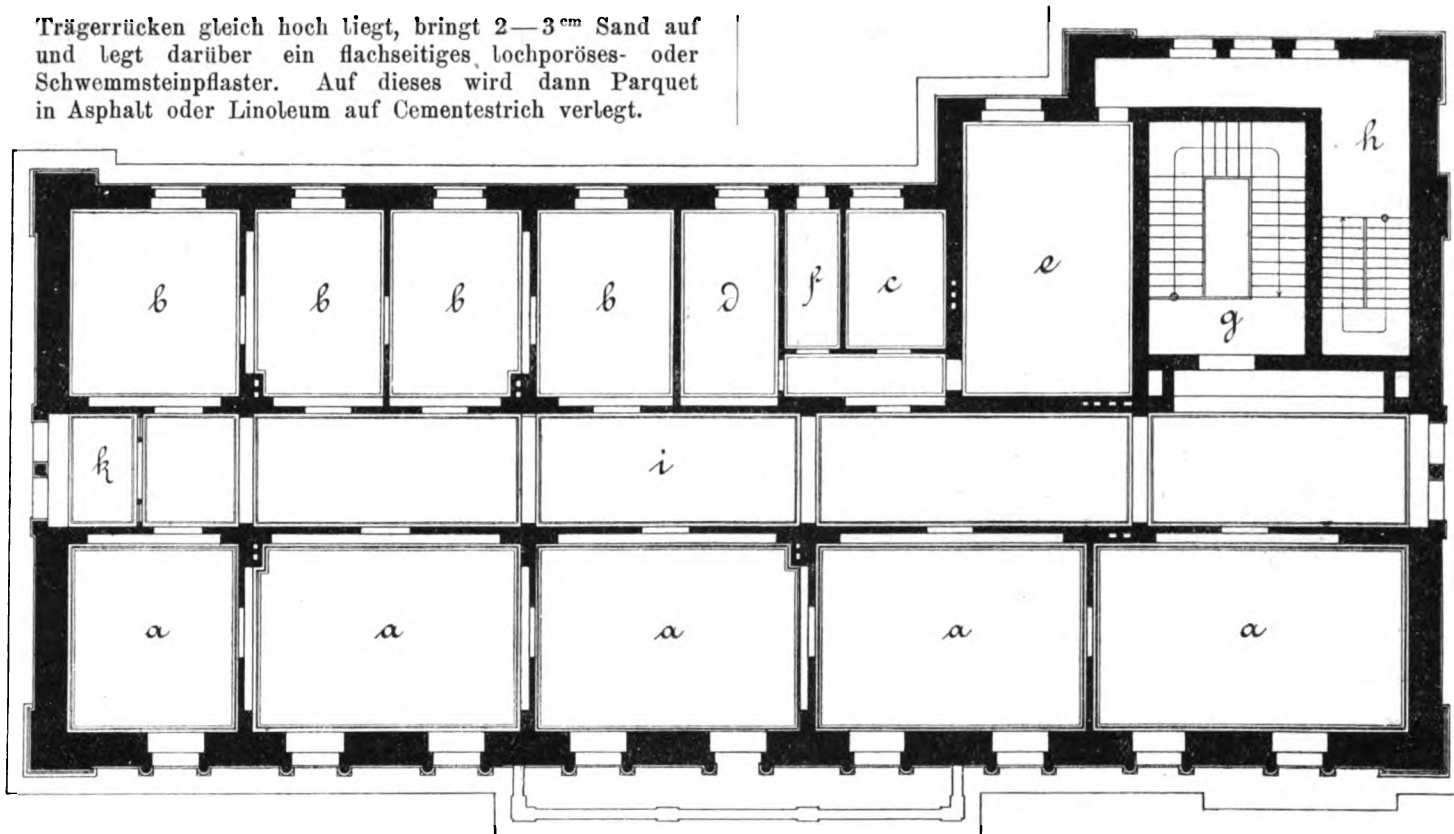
Grundriss des ersten und zweiten Stocks.
